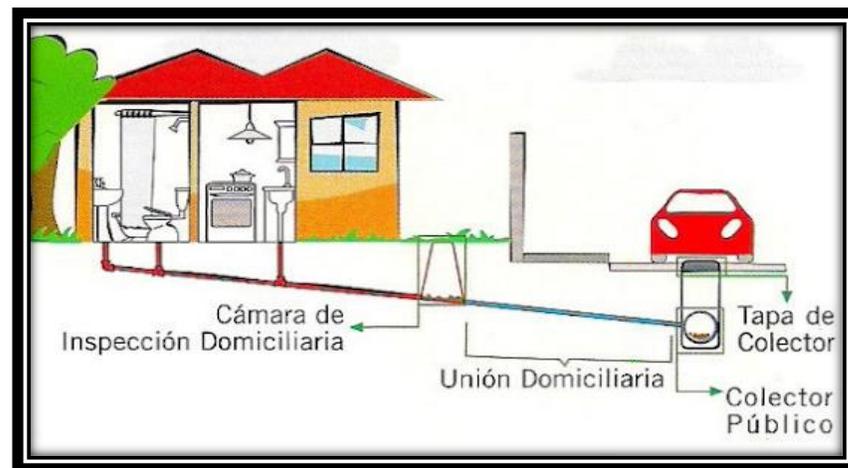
Esquema de Sistema Alcantarillado subterráneo
